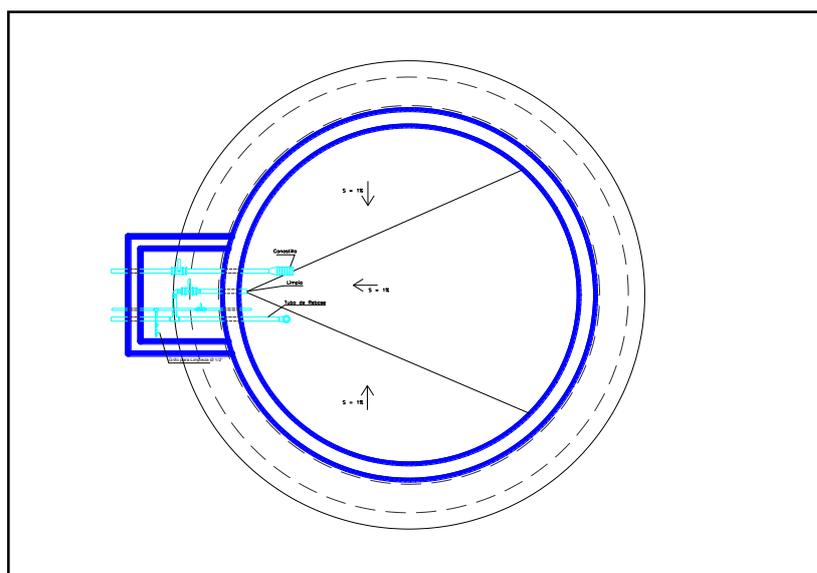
Vista en planta del reservorio apoyado circular proyectada
